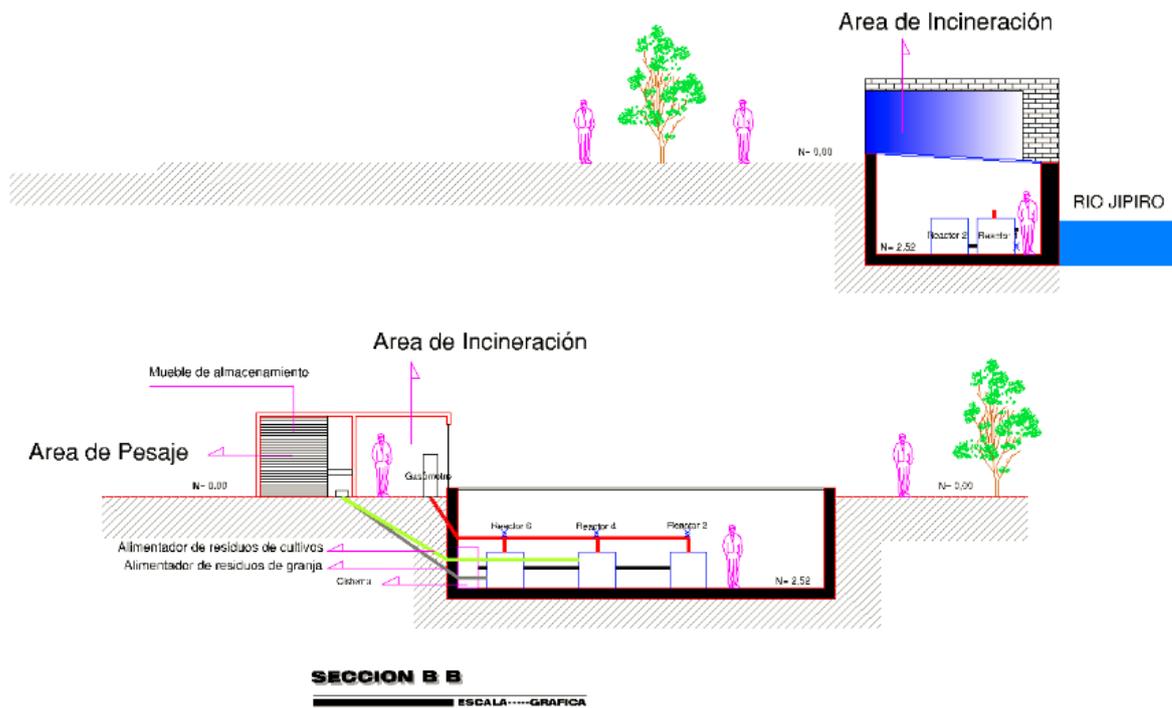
Detalles de la obra civil propuesta para el emplazamiento del sistema de biodigestores en el PRJ. Diseño de autores
